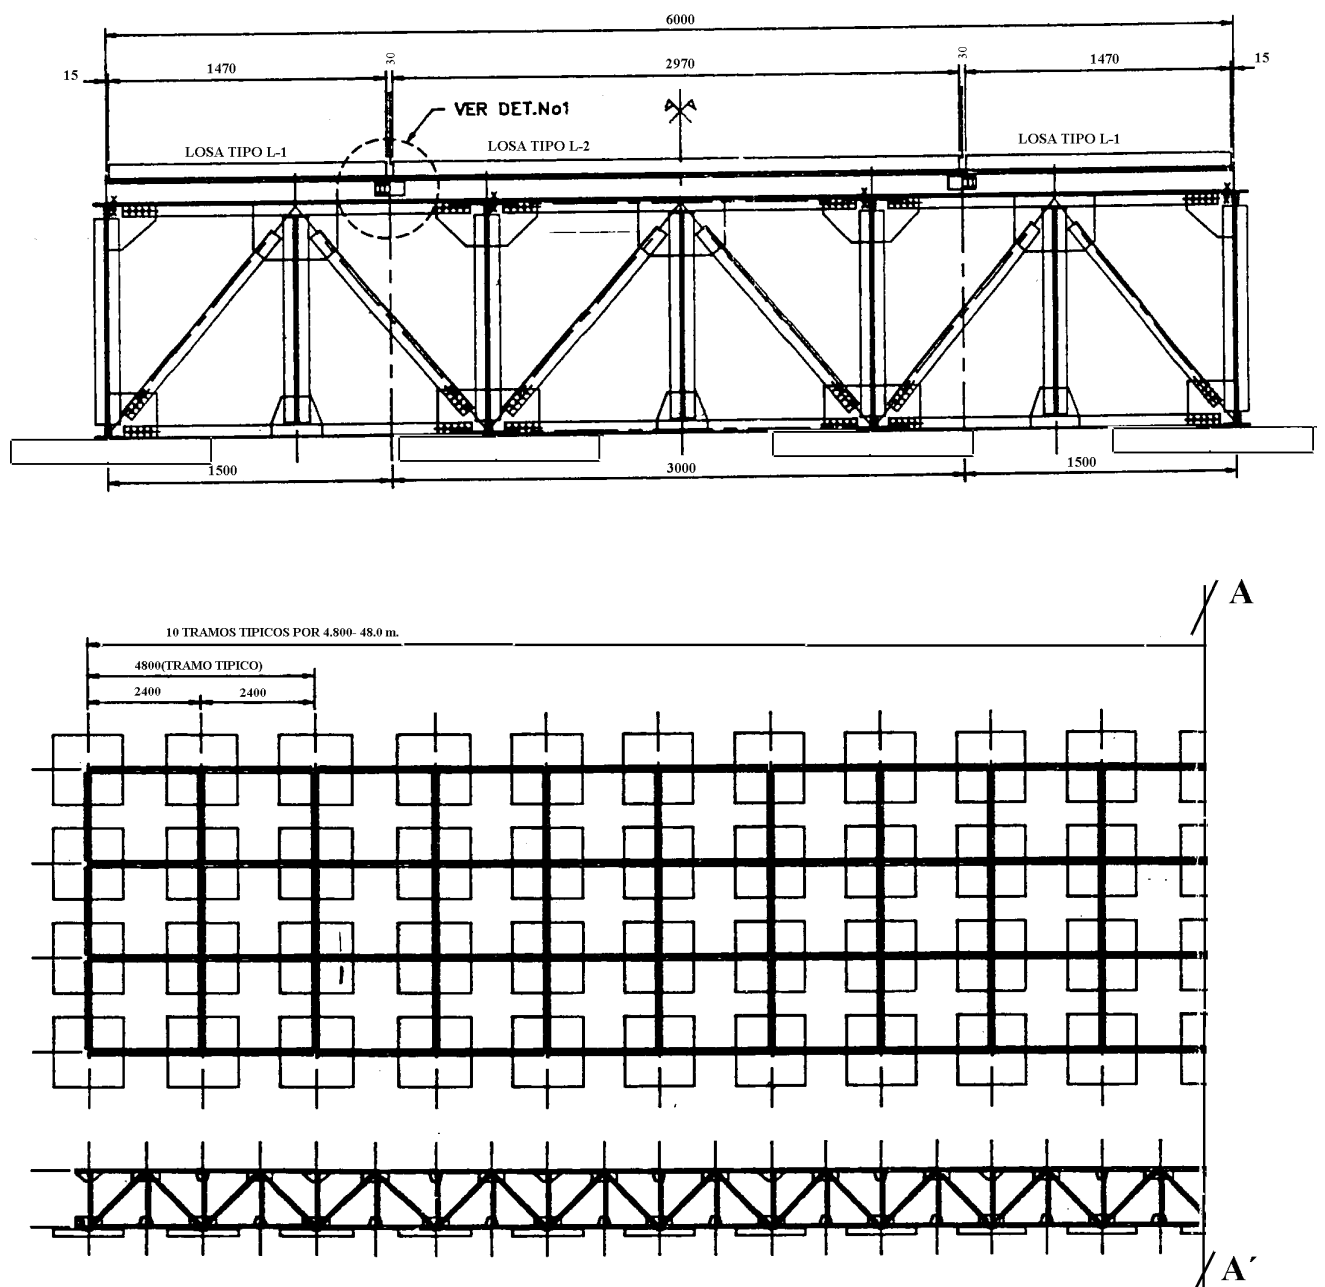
Cerchas Metálicas – Vista en corte y en planta
